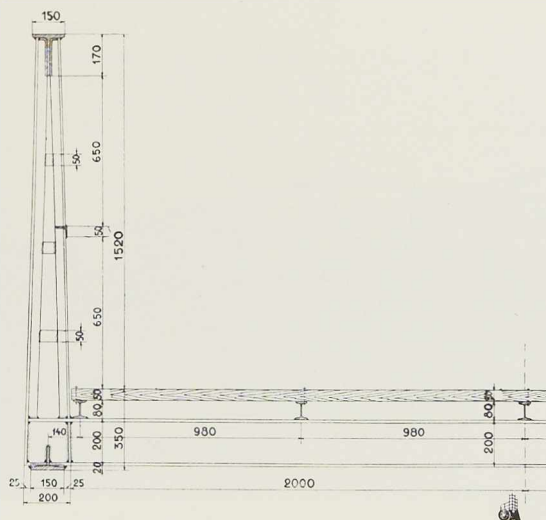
Coupe transversale des ponts. On notera l'assemblage de la maîtresse poutre et de l'entretoise.
